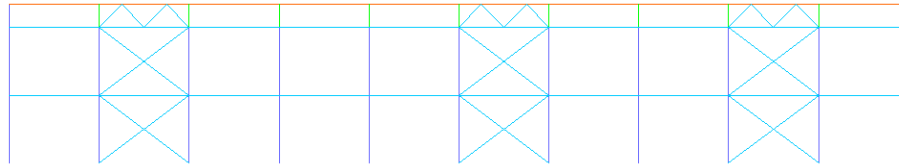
Contraventamento dos pilares, onde foi necessária a introdução de uma longarina metálica.
